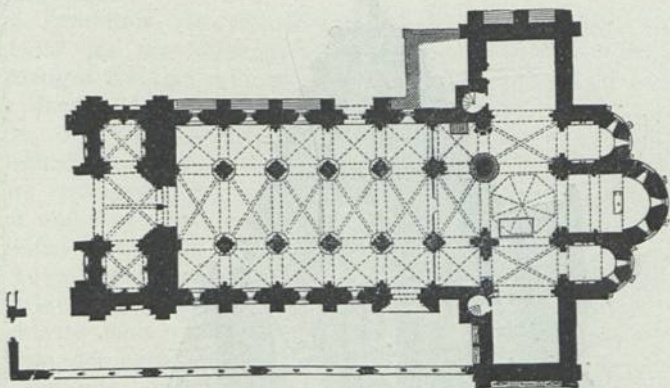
Grundriss von S. Vicente zu Avila
